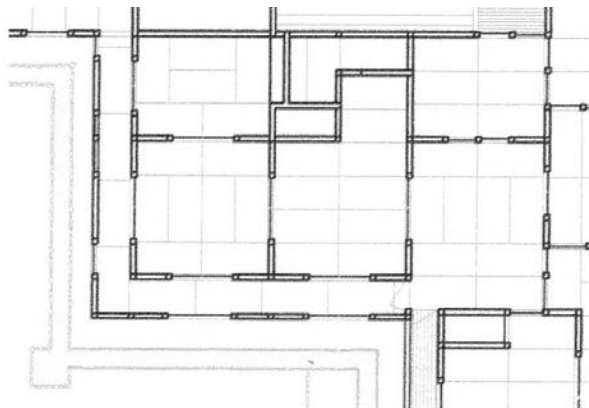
Planta principal. Sección por los paneles de cerramiento.
